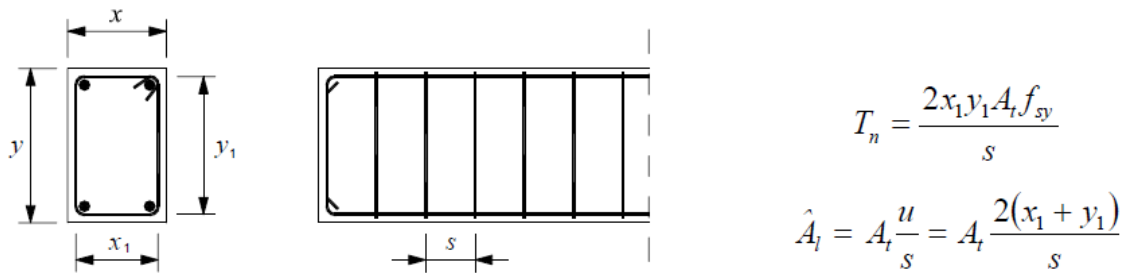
Viga de betão armado com secção rectangular [9]
